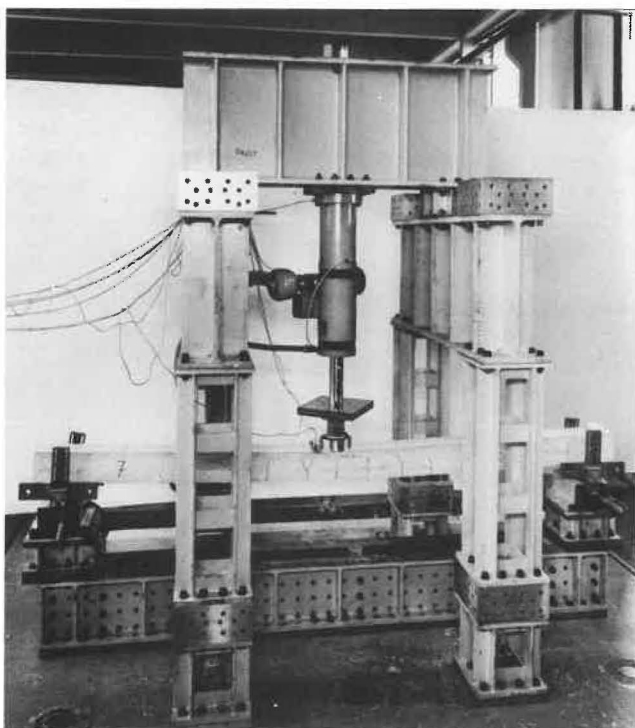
Versuchseinrichtung für Stoßbelastungen von Stahlbetonbalken
